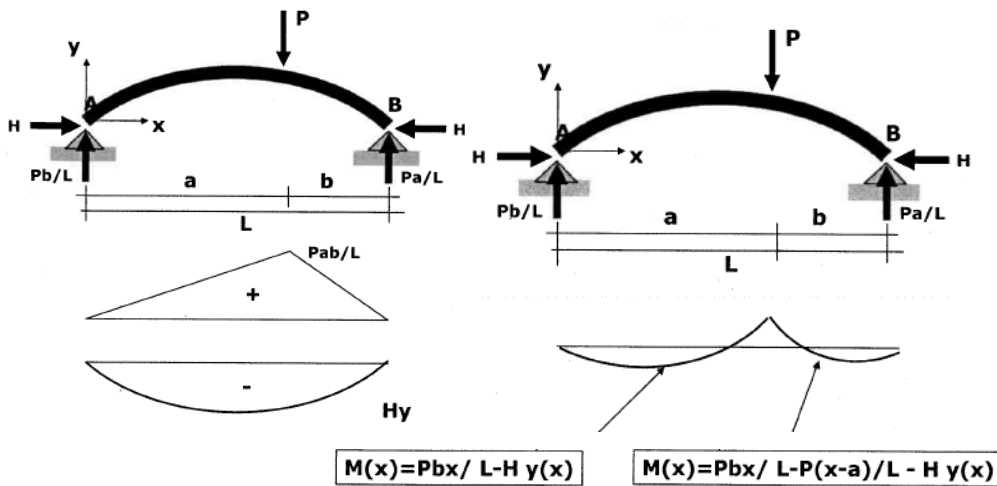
Digramme de moment fléchissant d'une poutre courbée.
